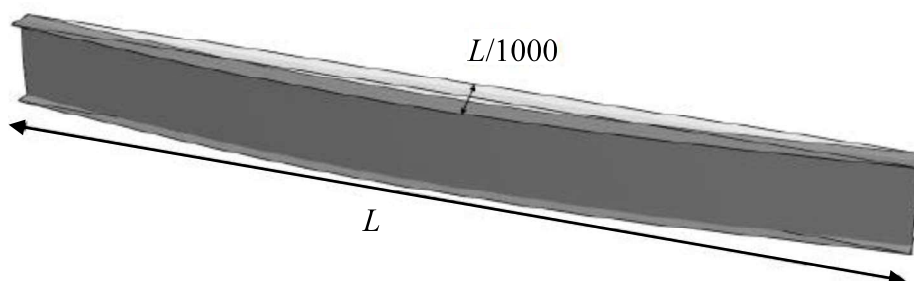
Imperfeição geométrica inicial para os casos de flambagem global.
